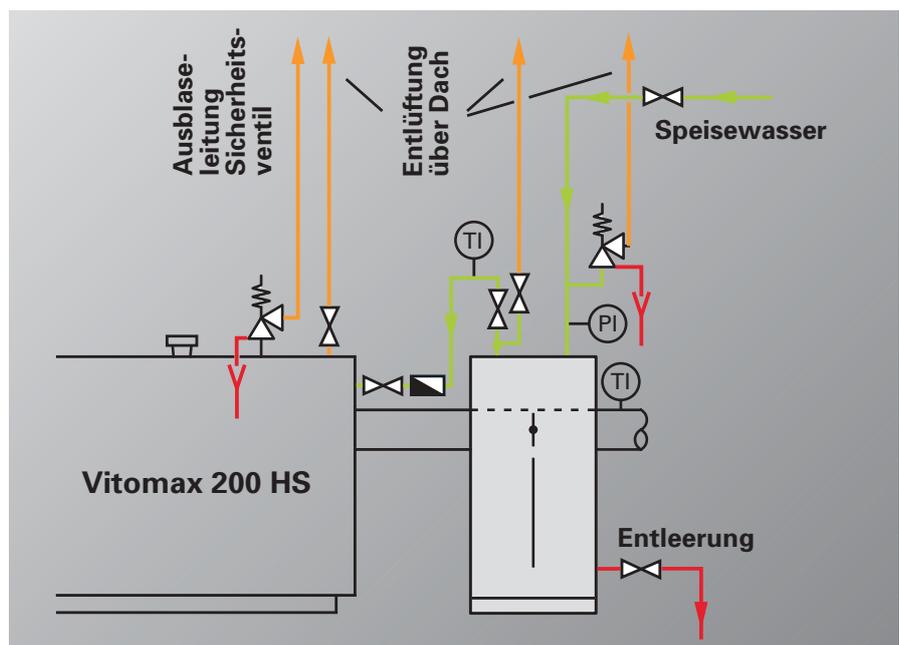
Schaltschema für einen absperrbaren ECO mit Armaturen und Bypass
